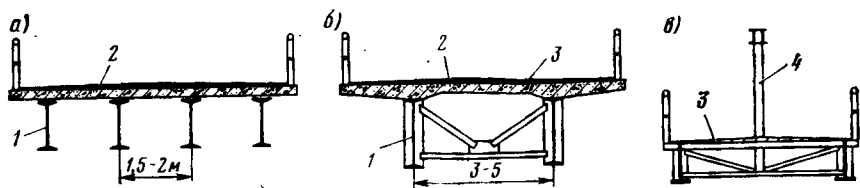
Поперечные сечения пешеходных мостов со сплошными балками и фермами:
